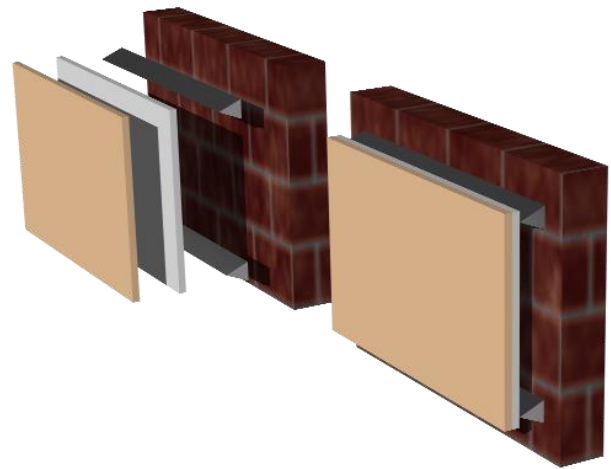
de izquierda: despiece del panel, el cual estará compuesto de placa de cantera laminada, refuerzo estructural. Apoyado sobre estructura ligera
